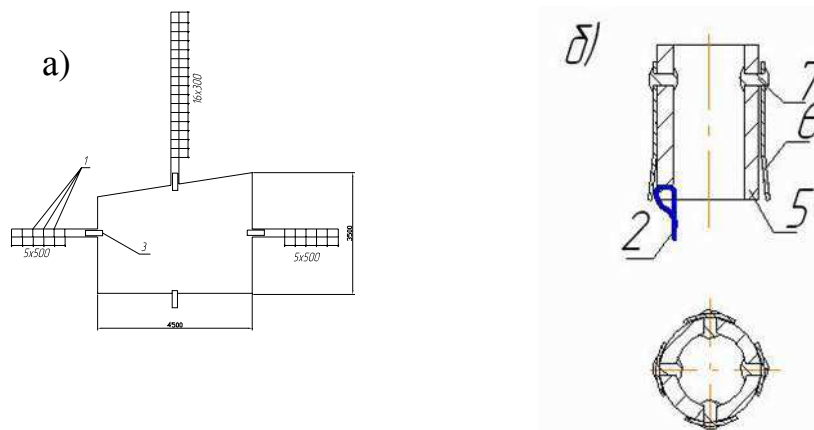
Схема замерной станции (а) и конструкция глубинного репера (б): 1 – глубинный репер; 2 – тяги глубинных реперов; 3 – кондуктор; 4 – замерное кольцо; 5 – отрезок стальной трубы; 6 – стальная полоса; 7 – заклепка.
